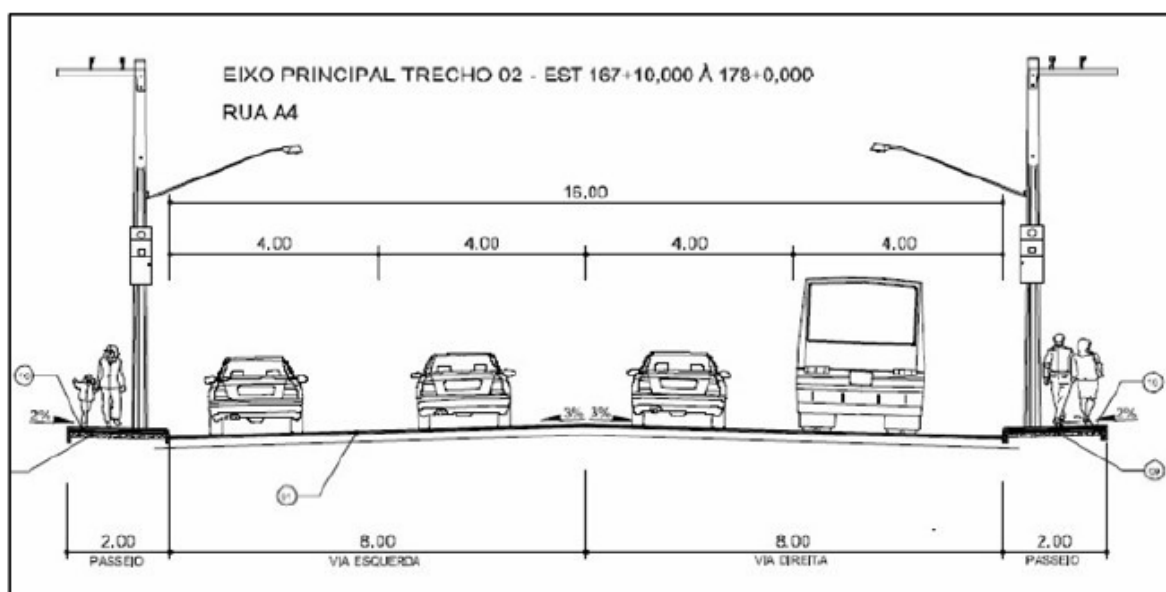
Via Perimetral: Perfil transversal dos trechos sobre via existente
